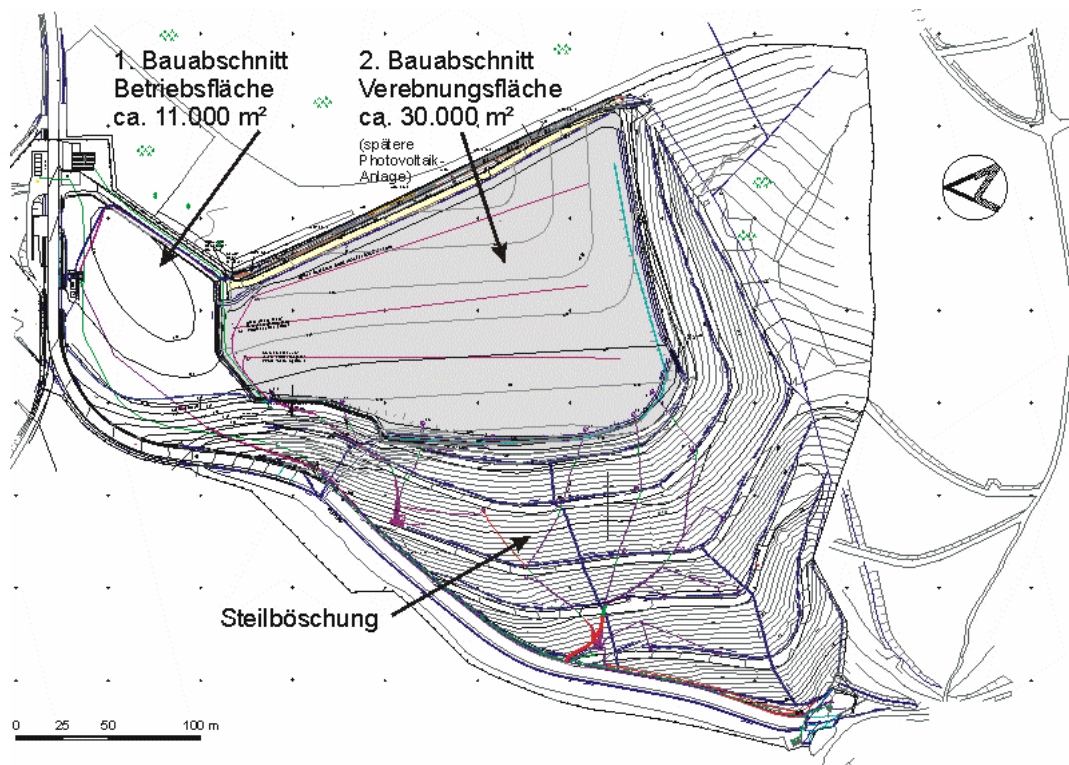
Lageplan Betriebsfläche Ramsklinge
